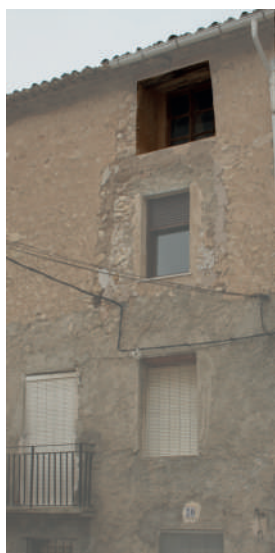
Ventana de la cuarta planta de la fachada principal.
